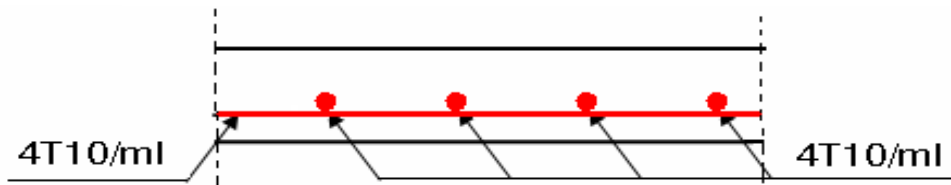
Vue en coupe du ferrailage de la dalle de l'ascenseur
